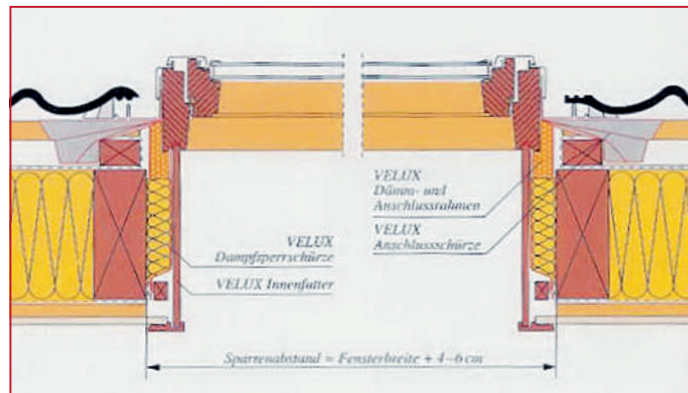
■ b) Dachflächenfensteranschlussdetails [Velux]
